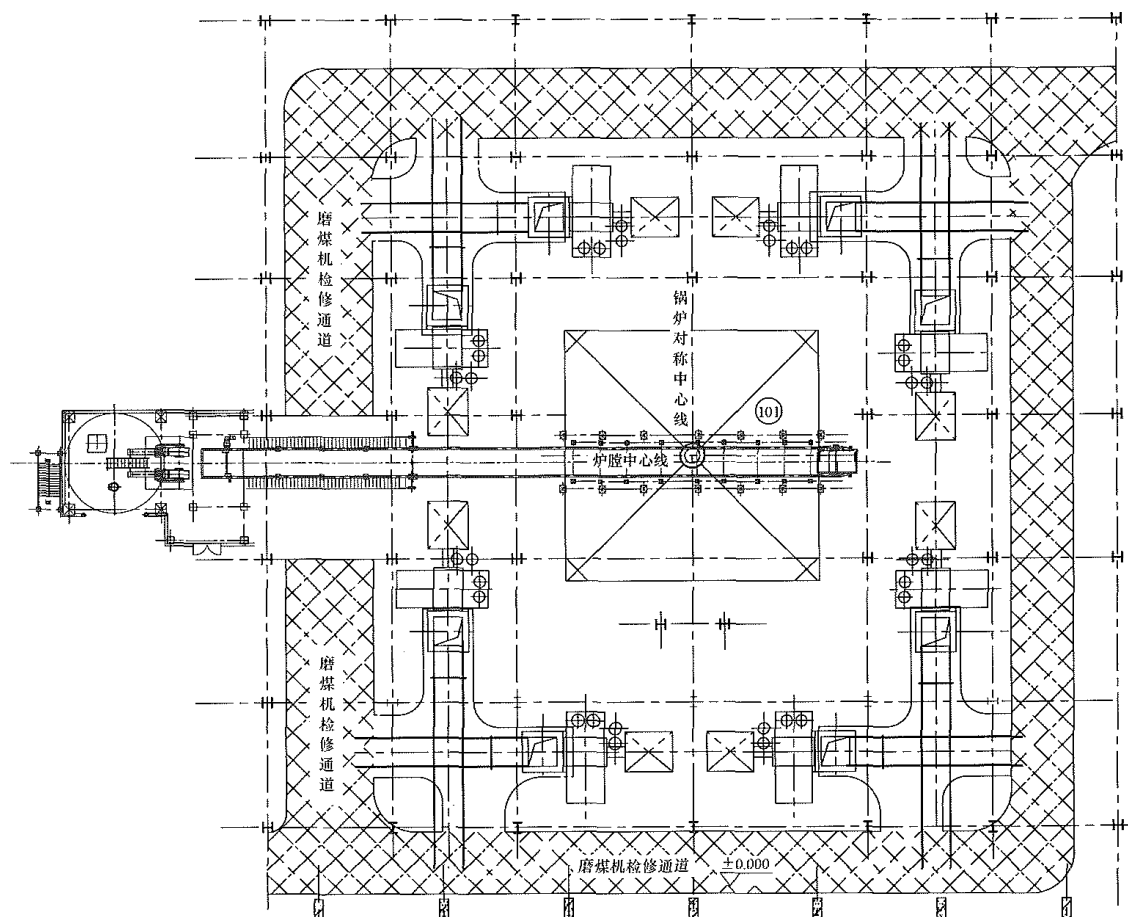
600MW 级机组风扇磨煤机侧煤仓零米平面布置图
